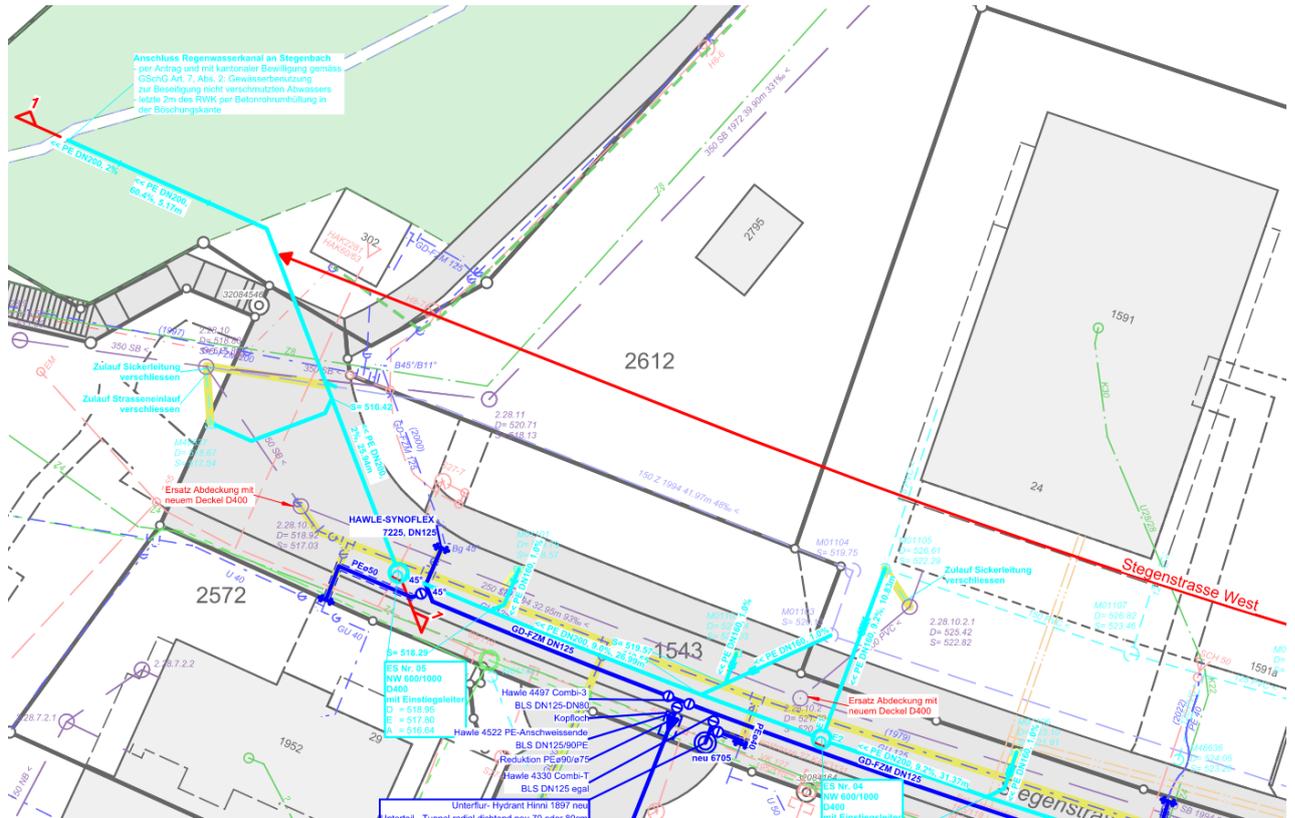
Ausschnitt Situationsplan 2725-301 – Bereich Anschluss Stegenbach
